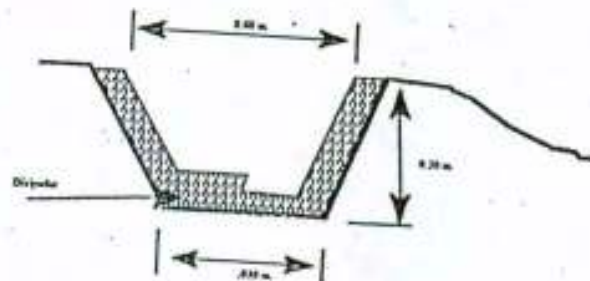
A. VISTA DE PERFIL OBRAS DE DRENAJE (CUNETAS)
